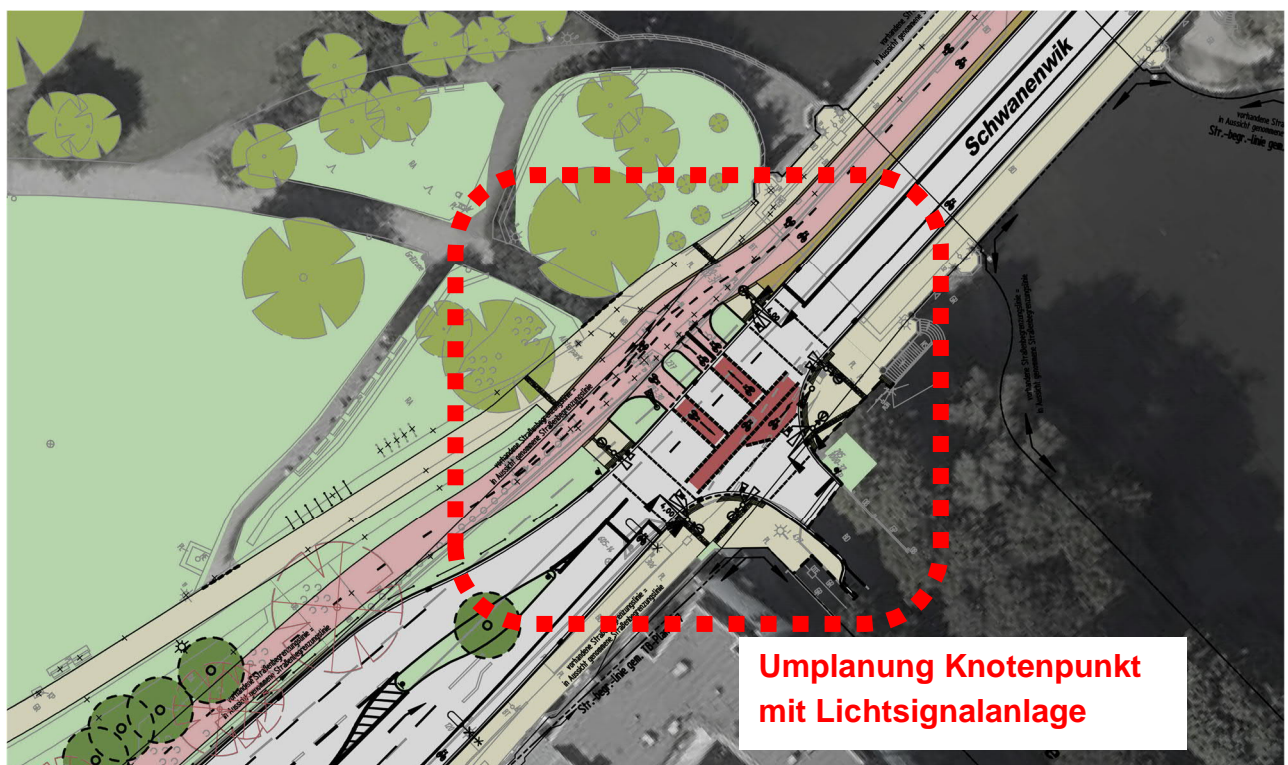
Lageplan-Ausschnitt mit Knotenpunkt Schwanenwik / Armgartstraße
